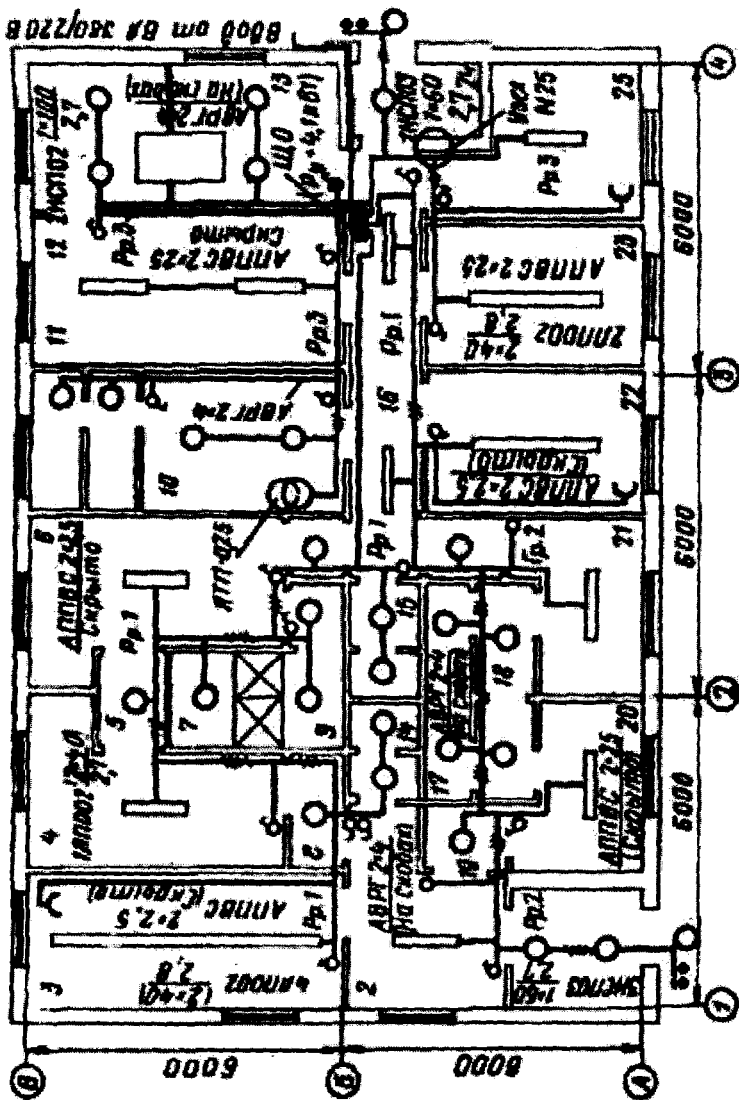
Электрическая схема на осветительной электропроводки на плане здания (высота потока 3,0 м)
